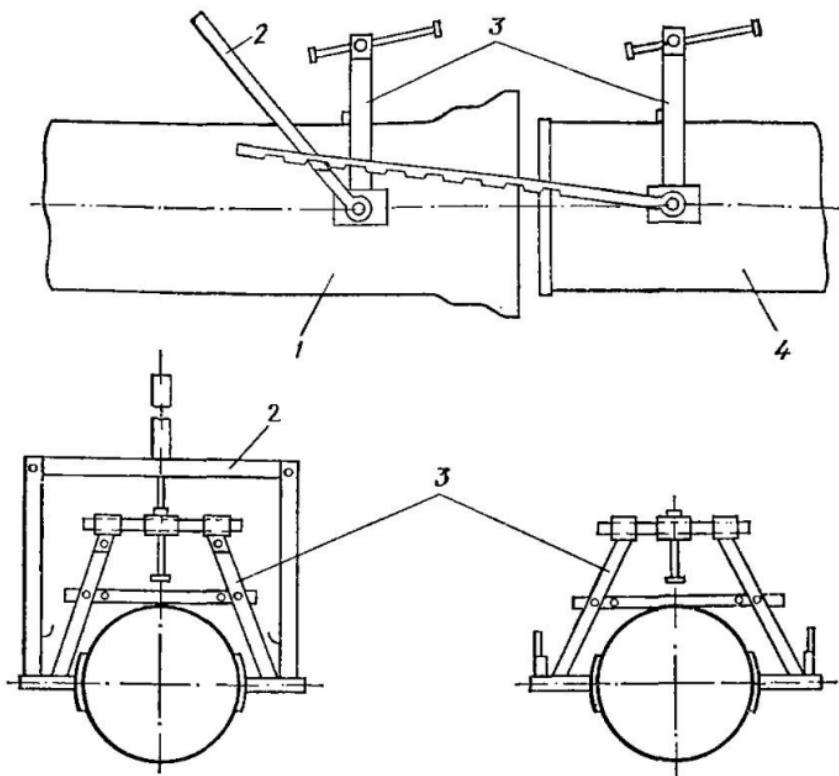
Монтажное приспособление реечного типа с винтовыми захватами
